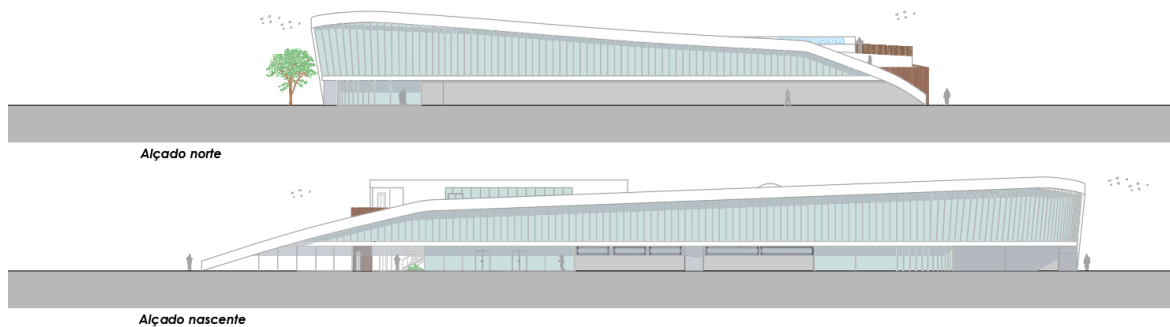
ALÇADOS DAS FACHADAS NORTE E NASCENTE
